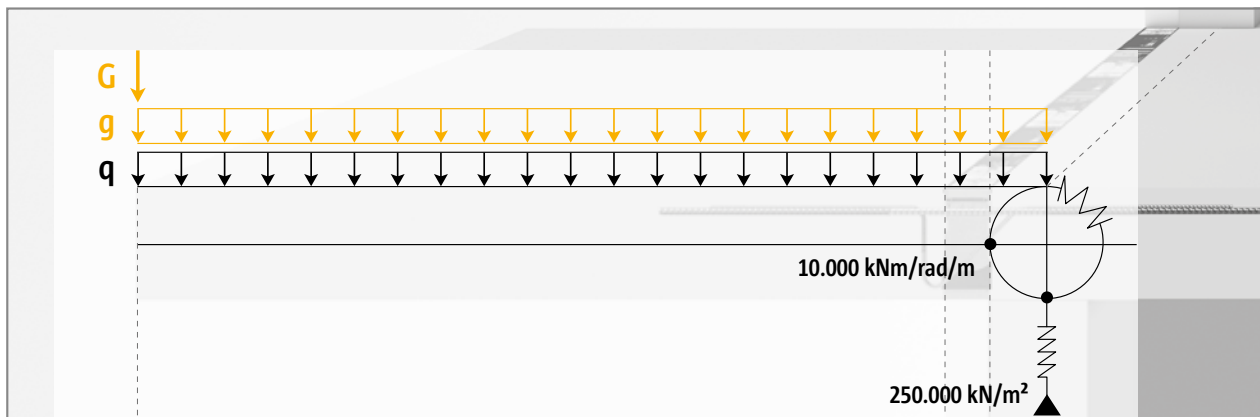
Schöck Isokorb® tip K: statičen sistem
